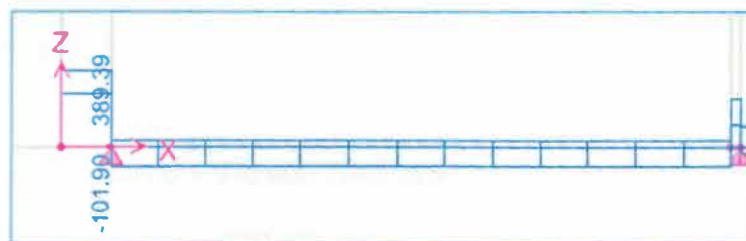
DFC de viga de cimentación entre zapata Z-3 y Z-4
